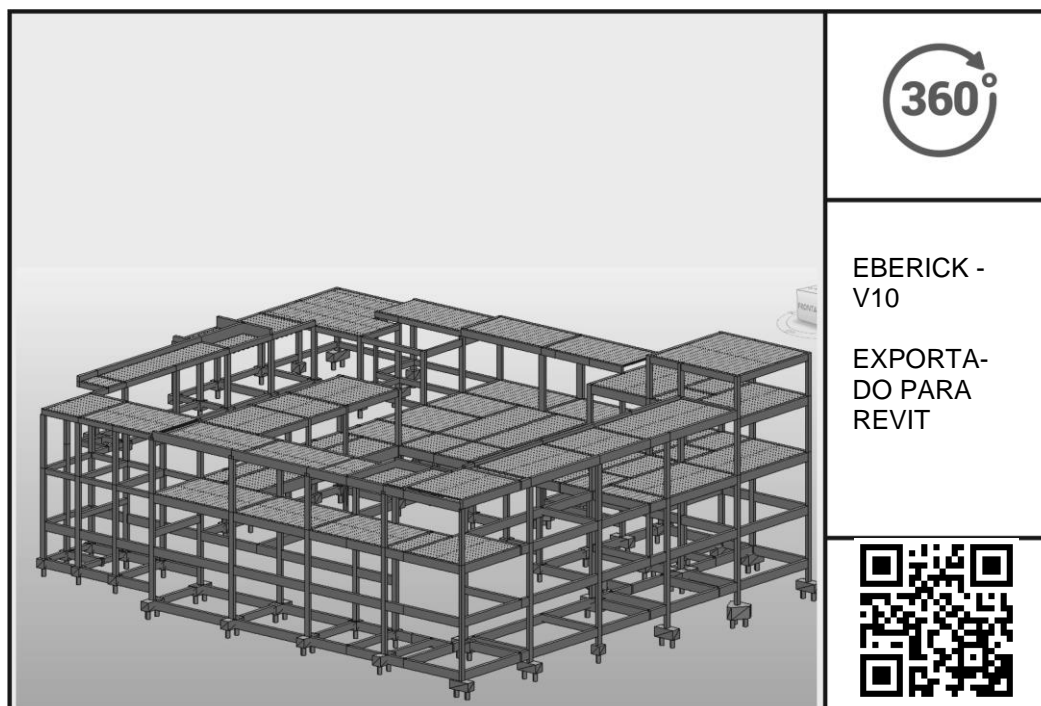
Estrutura de Concreto Armado do Centro Cultural
